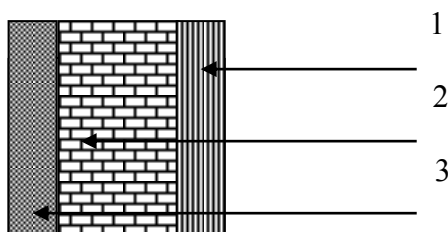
Coupe verticale d'un mur extérieur
